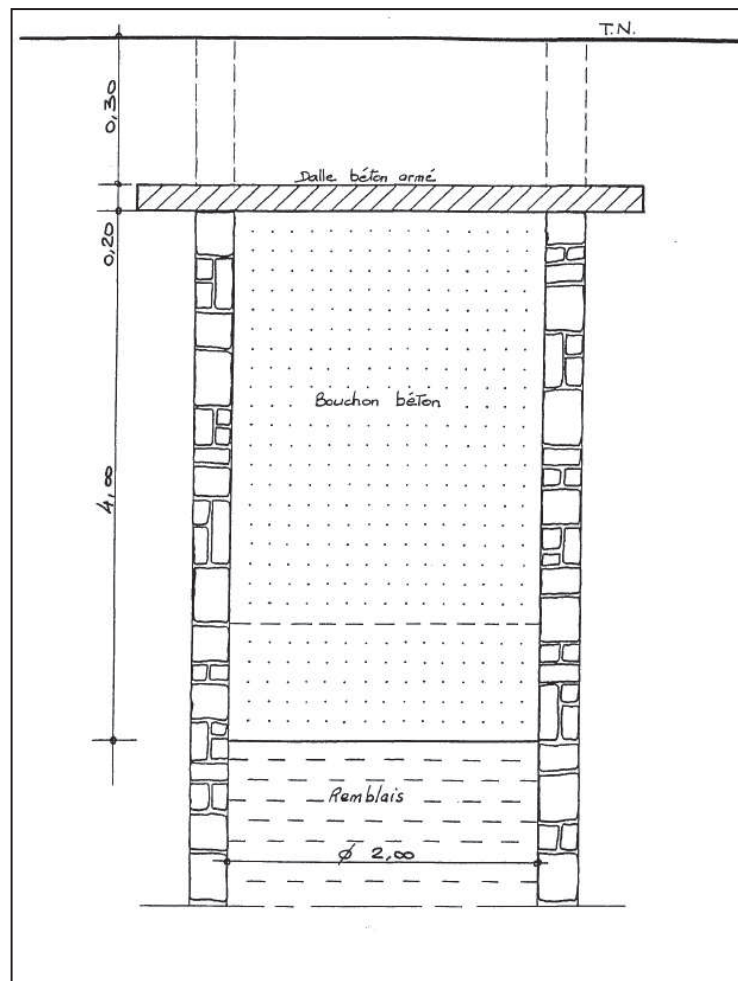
Schéma de mise en place du bouchon béton du Puits du Feu
